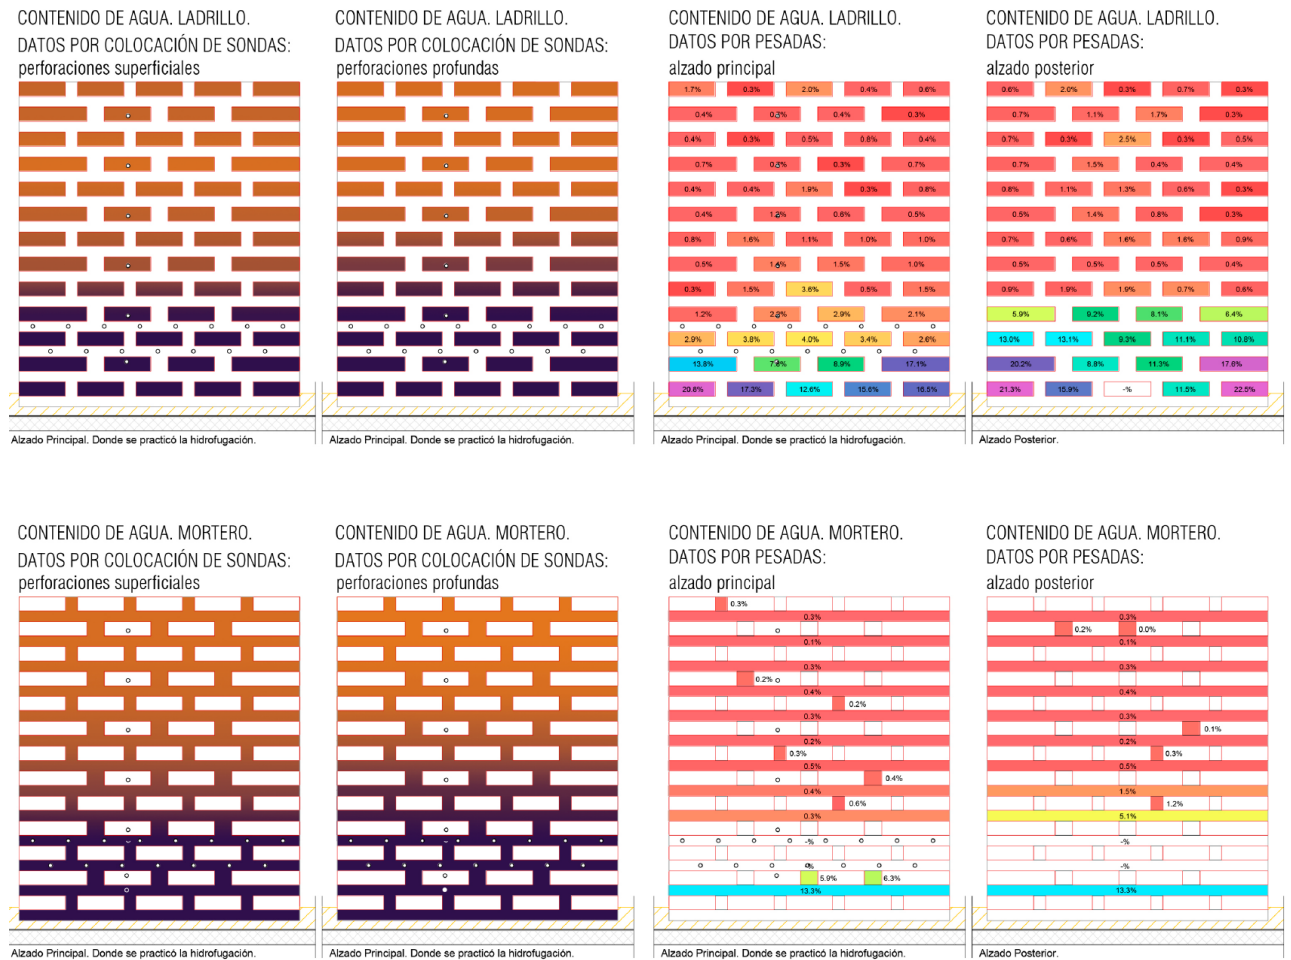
Alzados muro de 1 ½ asta de ladrillo de tejar con barrera hidrófuga. Datos en ladrillos (fila superior) y en argamasa (fila inferior)
